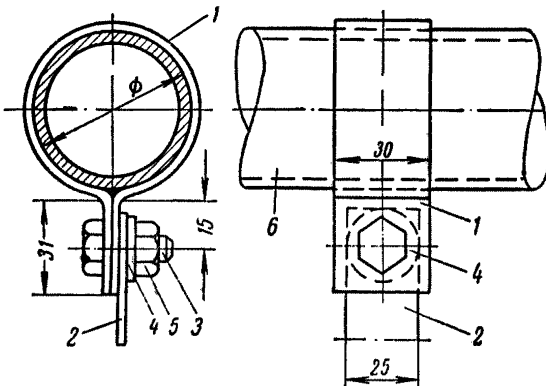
Присоединение заземляющего проводника к трубопроводу с помощью хомута (внутренний диаметр хомута соответствует наружному диаметру трубопровода):
